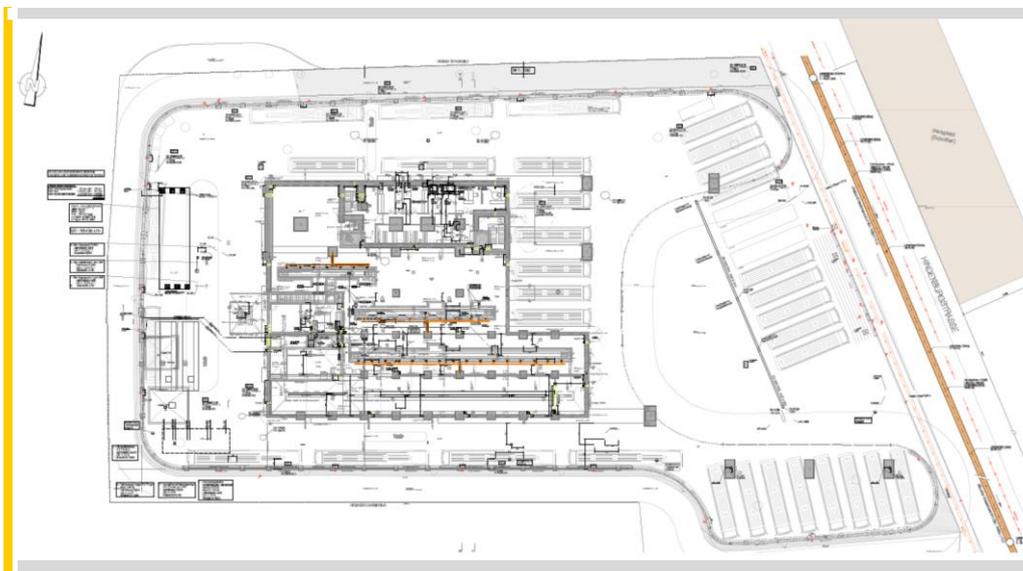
Grundriss Betriebshof Hindenburgstraße
